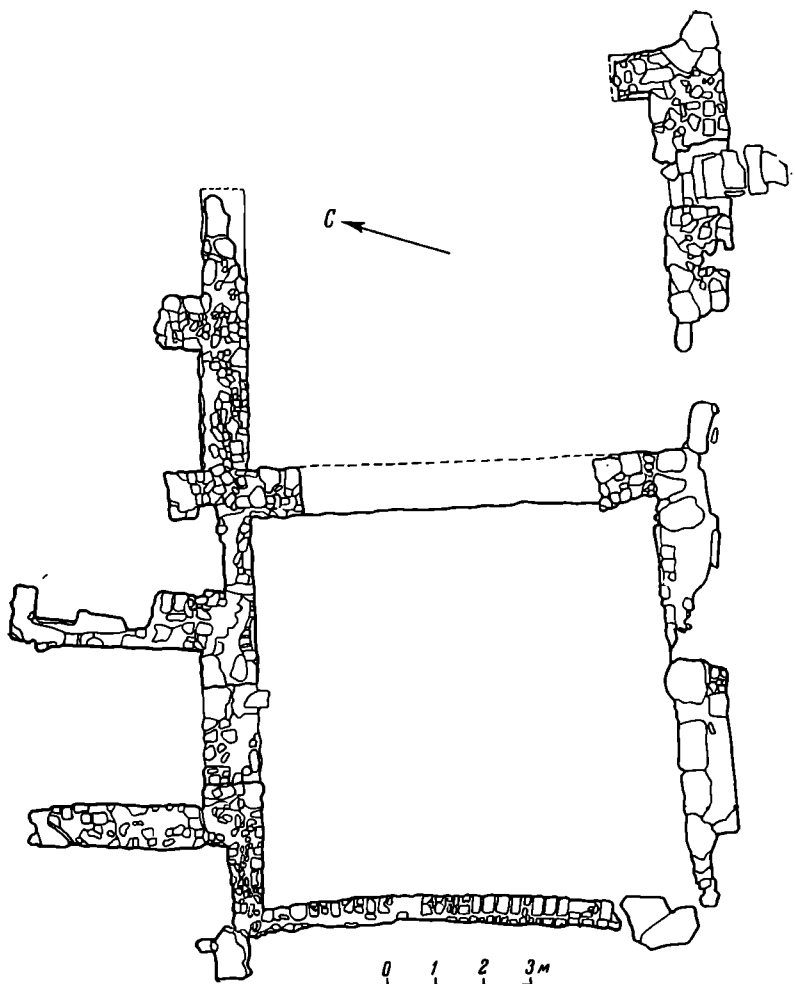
План дворцового здания XI в. в Переяславе-Хмельницком
